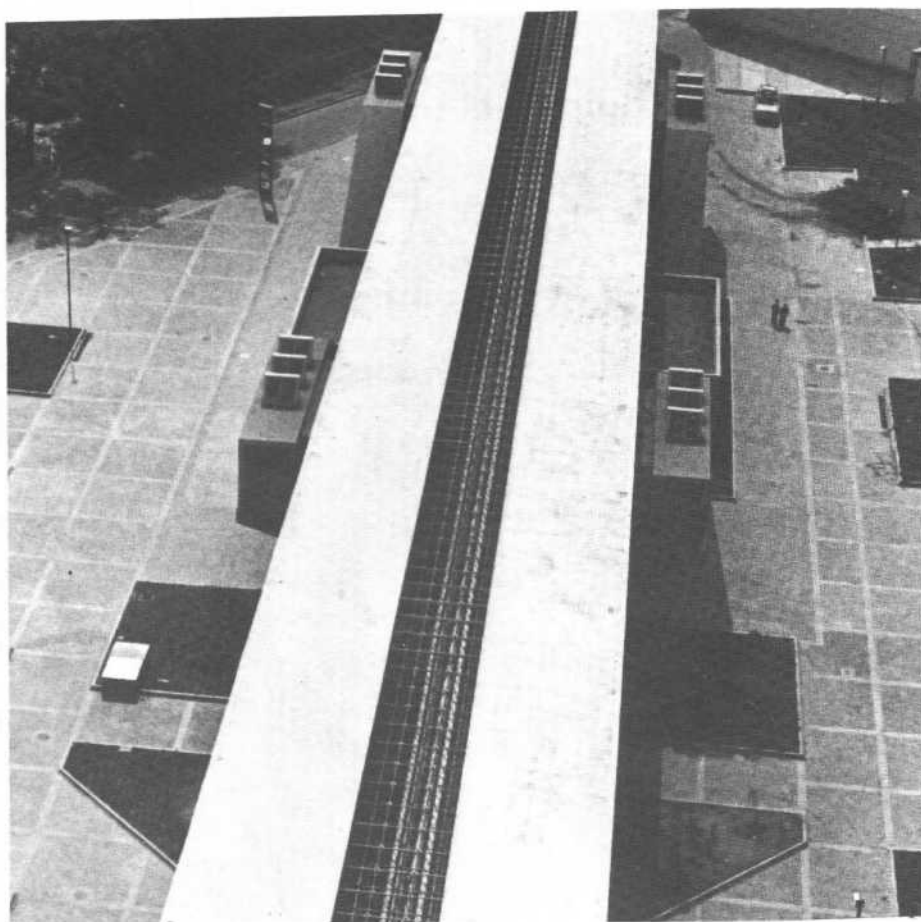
Vista plaza exterior. Estación Caño Amarillo (1983).
